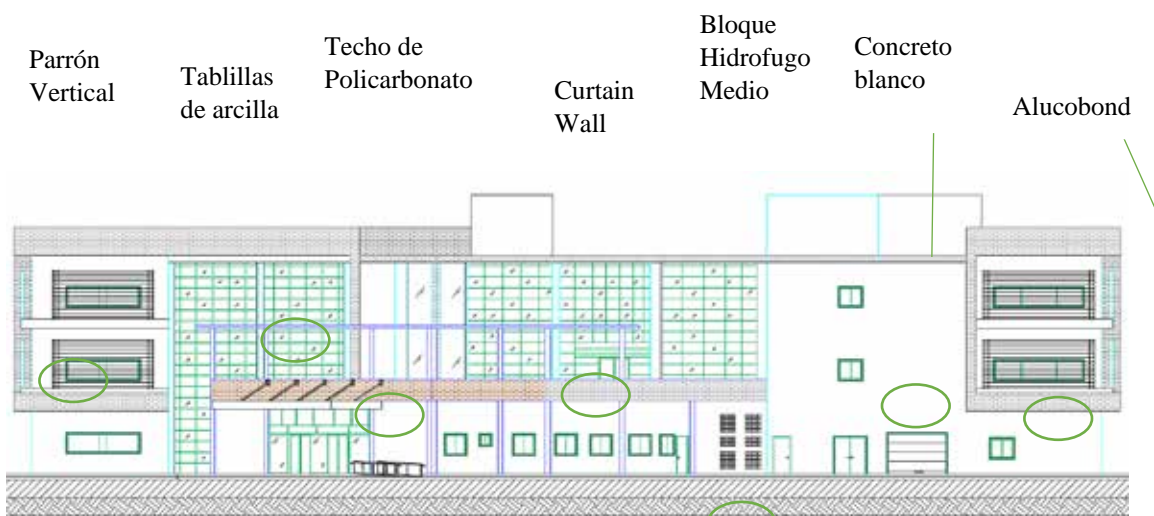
Revestimiento de paredes exteriores y cubiertas. Fachada Norte (2018)
